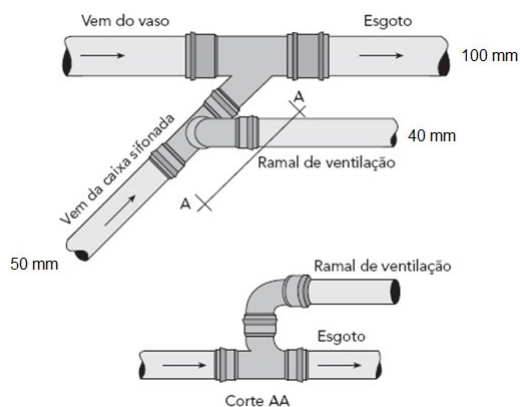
Detalhe da ventilação primária (ligação da ventilação no último pavimento)
